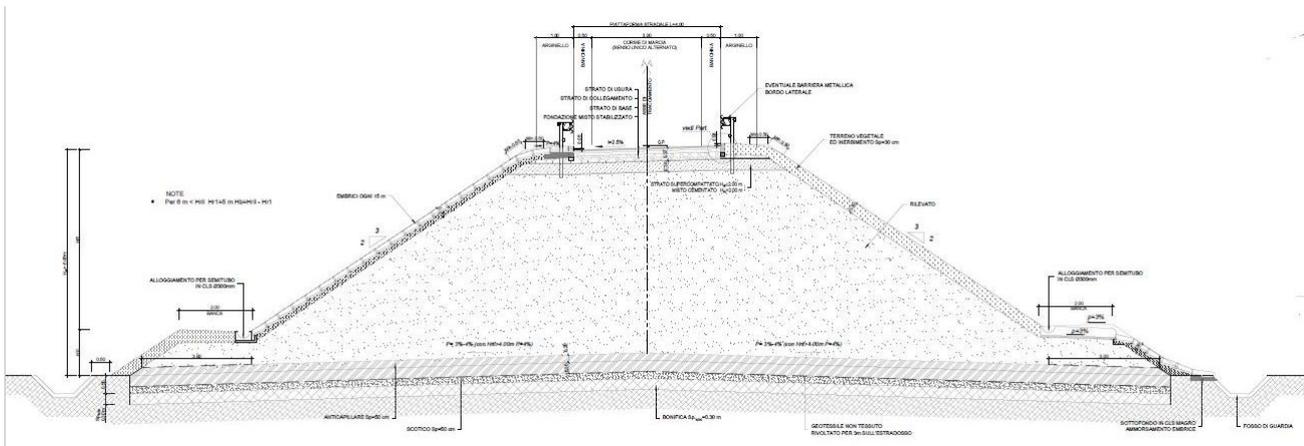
Dest. Particolare 4.0 m - sezione tipo in rilevato Hril > 6.00 m
